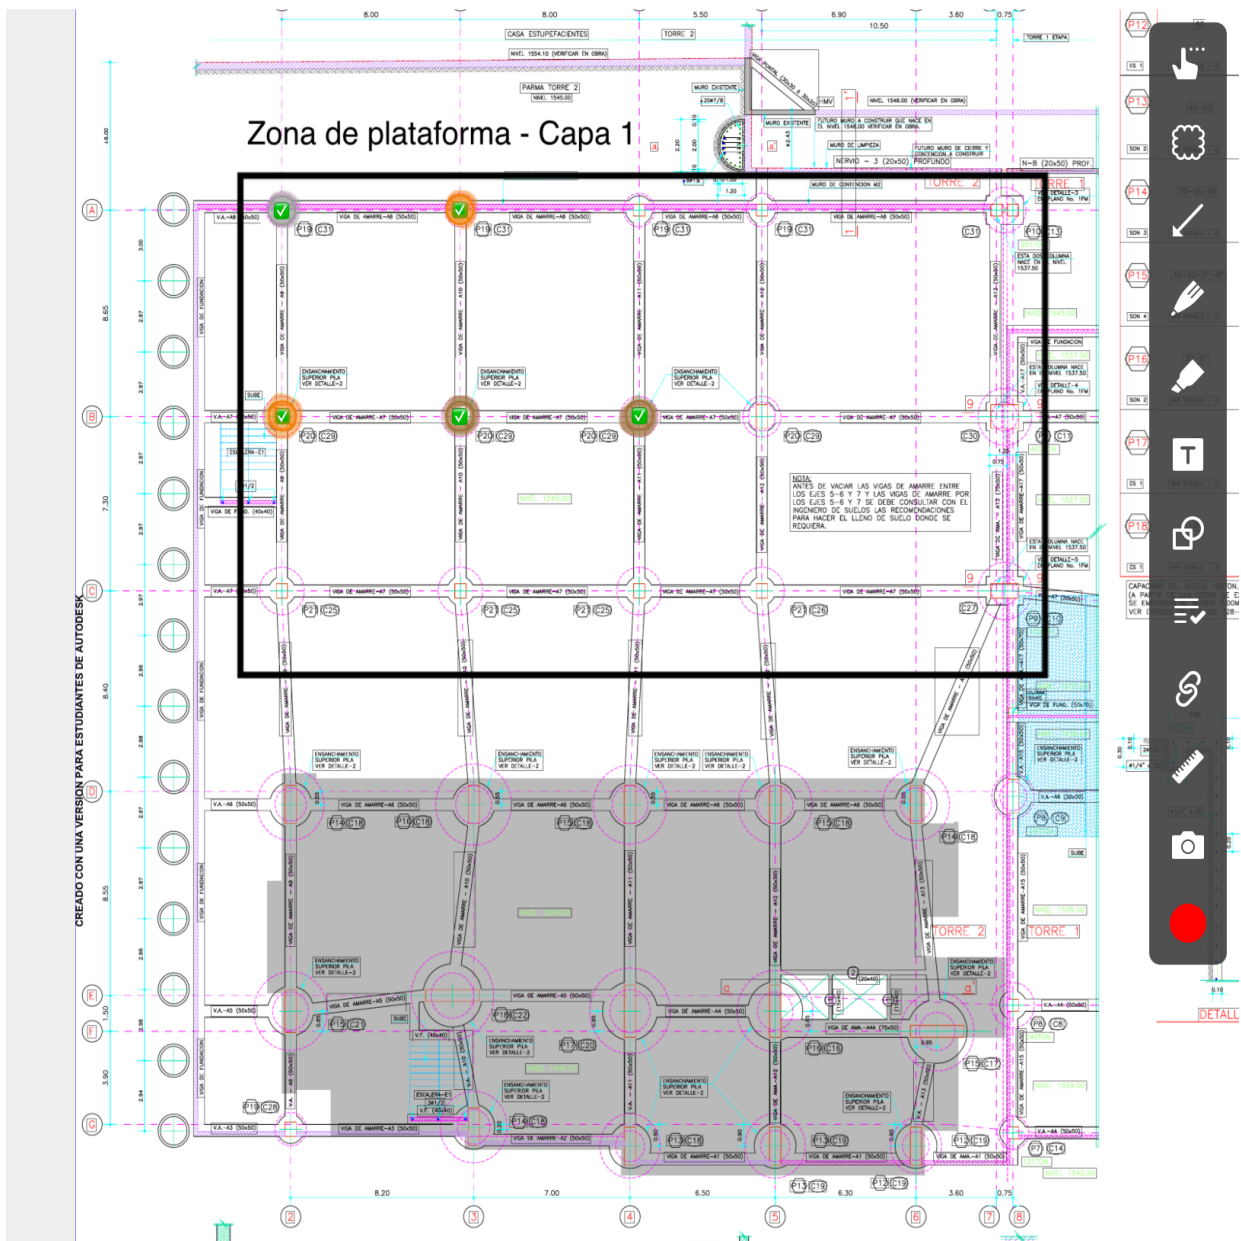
Excavación y vaciado del primer lote de pilas: Zona plataforma.
